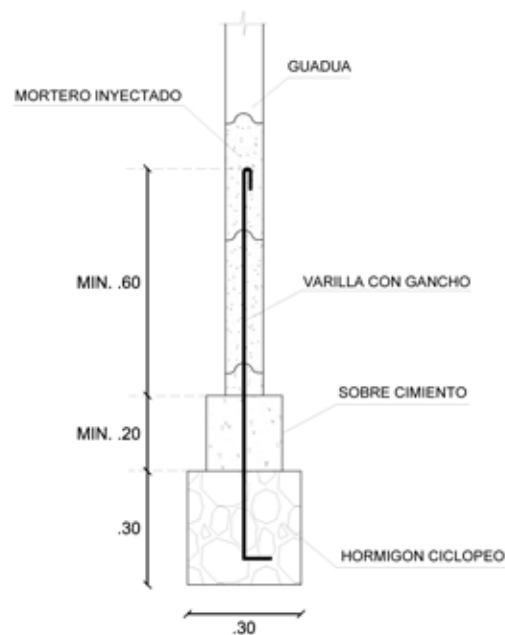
Unión pie-derecho a cimiento, en muros de bahareque sin soleras de madera. (Ministerio de la vivienda, construcción y saneamiento del Perú, 2012)
